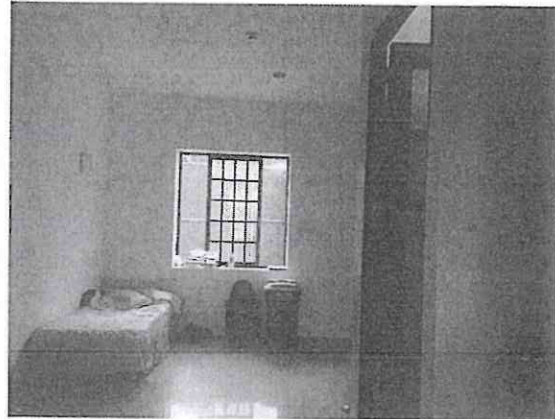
Muros y losas de las habitaciones de la casa hogar para varones, en buen estado estructural.
